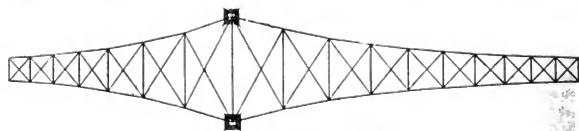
Viar-Viaduct. Grundriss.
